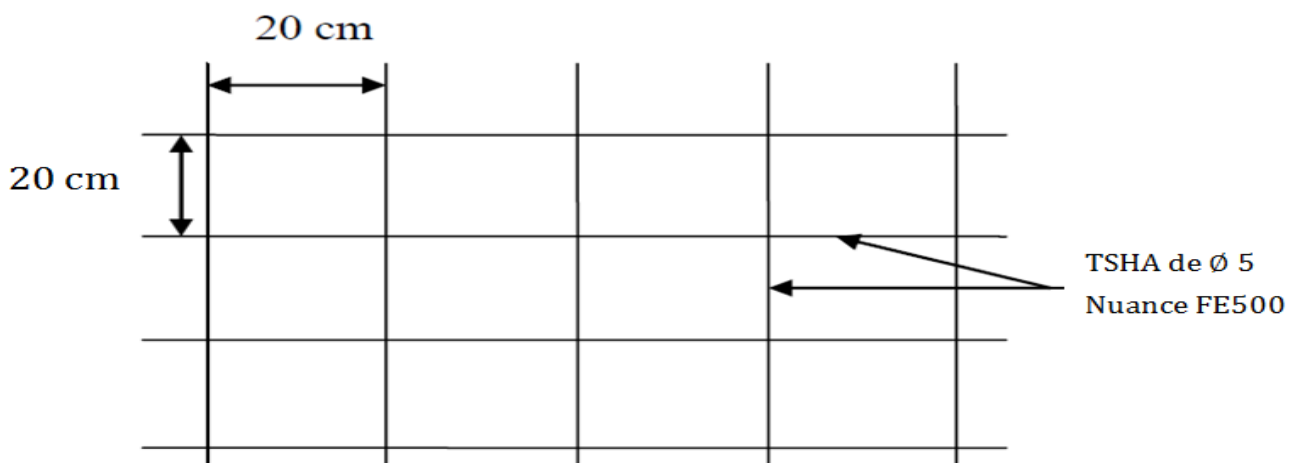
Ferrailage de la dalle compression en TSHA
